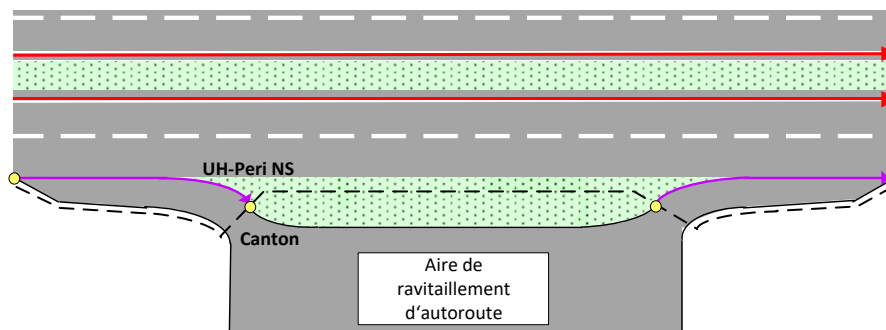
Exemple d'axes de rampes dans une aire de ravitaillement d'autoroute
